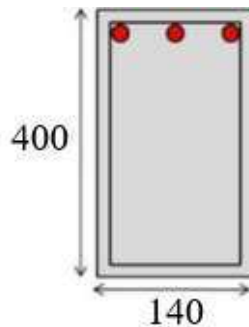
Dimensões da viga com armadura negativa (em mm)
